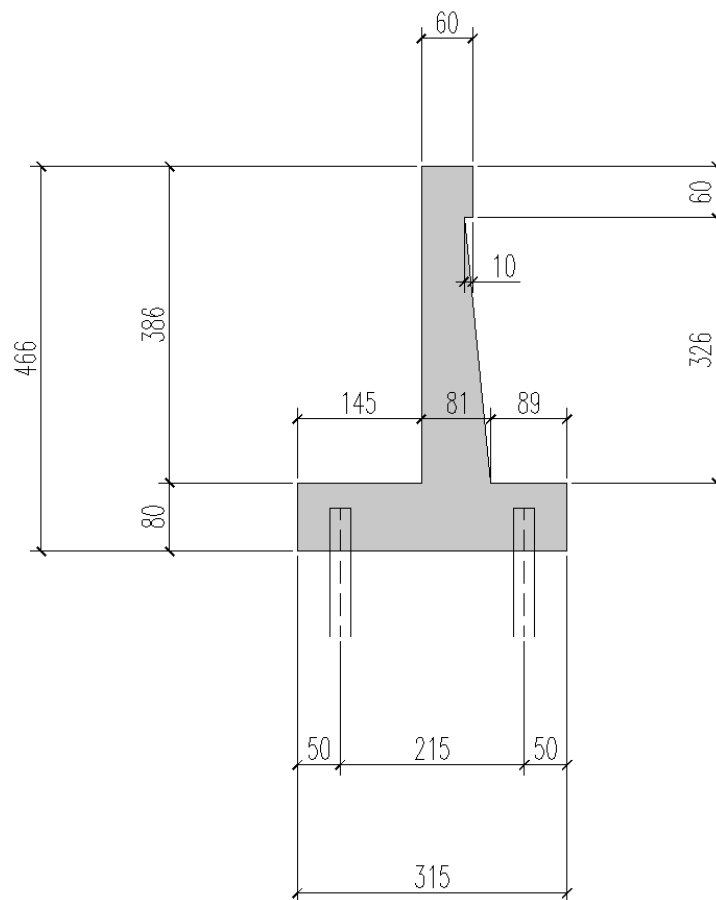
Carpenteria della Sezione ad altezza maggiore del Muro M01
